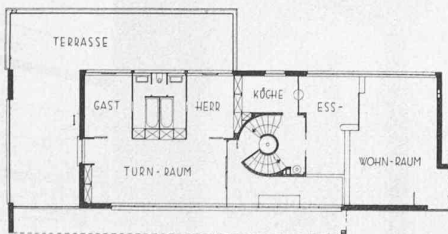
und 11. Haus des Fliegers. Grundrisse 1 : 400.
